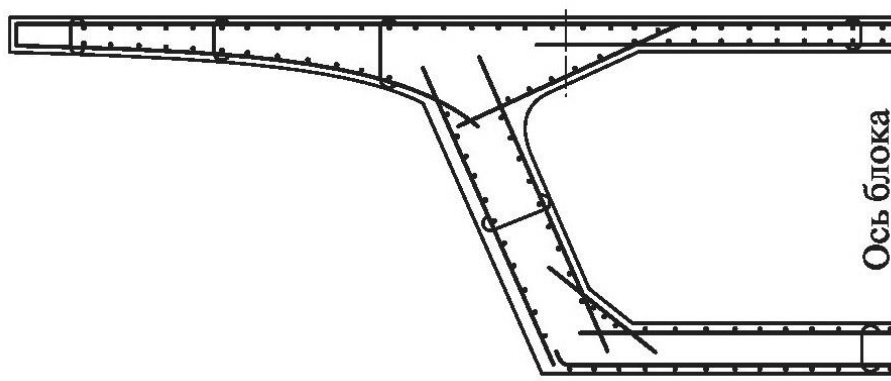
Армирование коробчатого поперечного сечения ненапрягаемой арматурой
